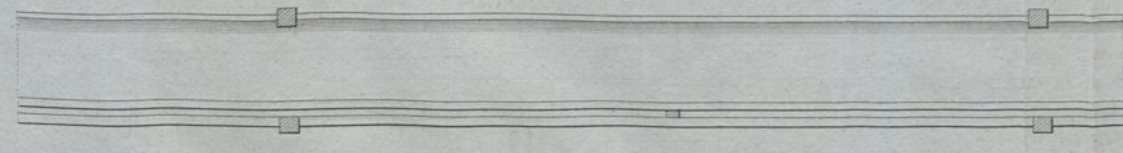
Fussboden aus I-Eisen nach dem System von Bleuze. Grundriss nach dem Maasstab von 1:0.02.
